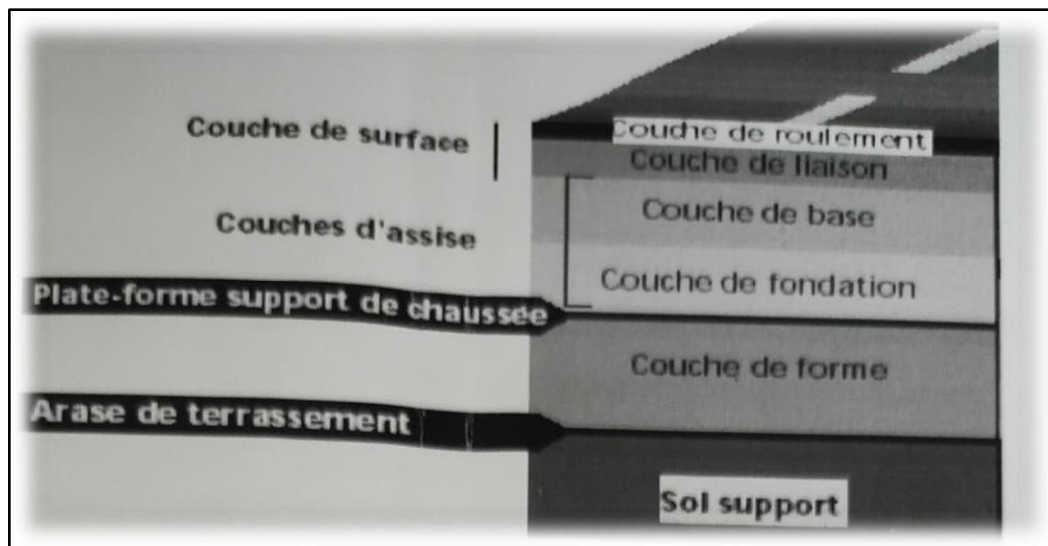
Les différentes couches qui constituent la structure de la chaussée [7]
